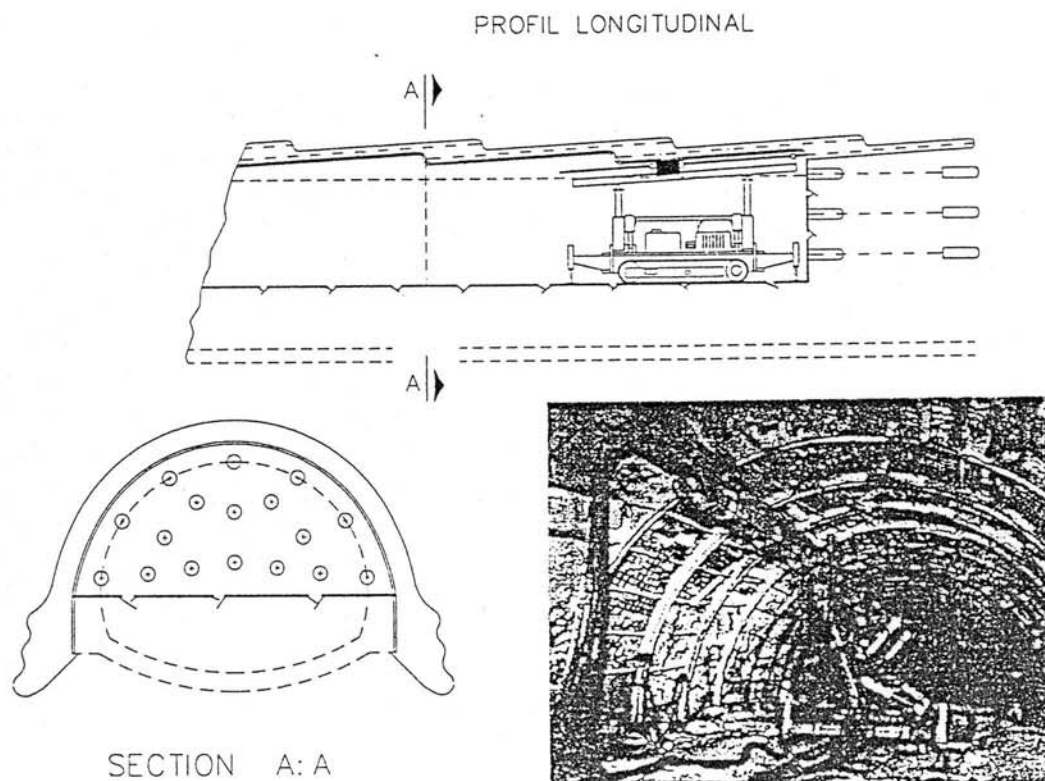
avancement après jet-grouting horizontal et à section partialisée.
